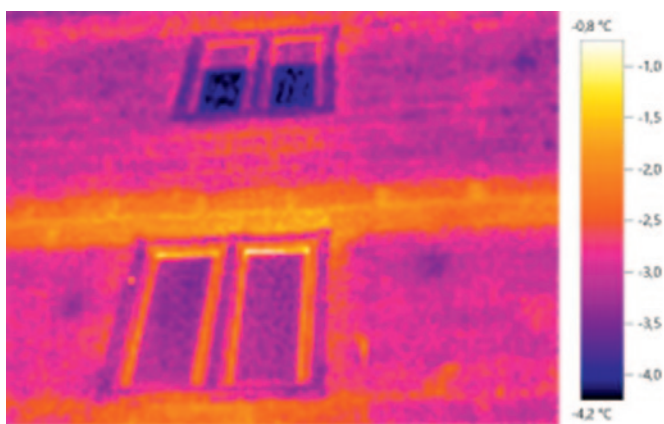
Теплопроводные включения в уровне межэтажных перекрытий
